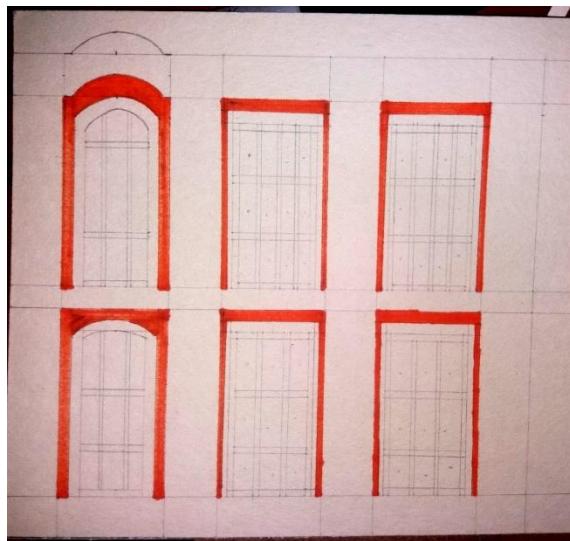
Creación del Patrón de Referencia, para la Construcción de las Columnas a Escala
